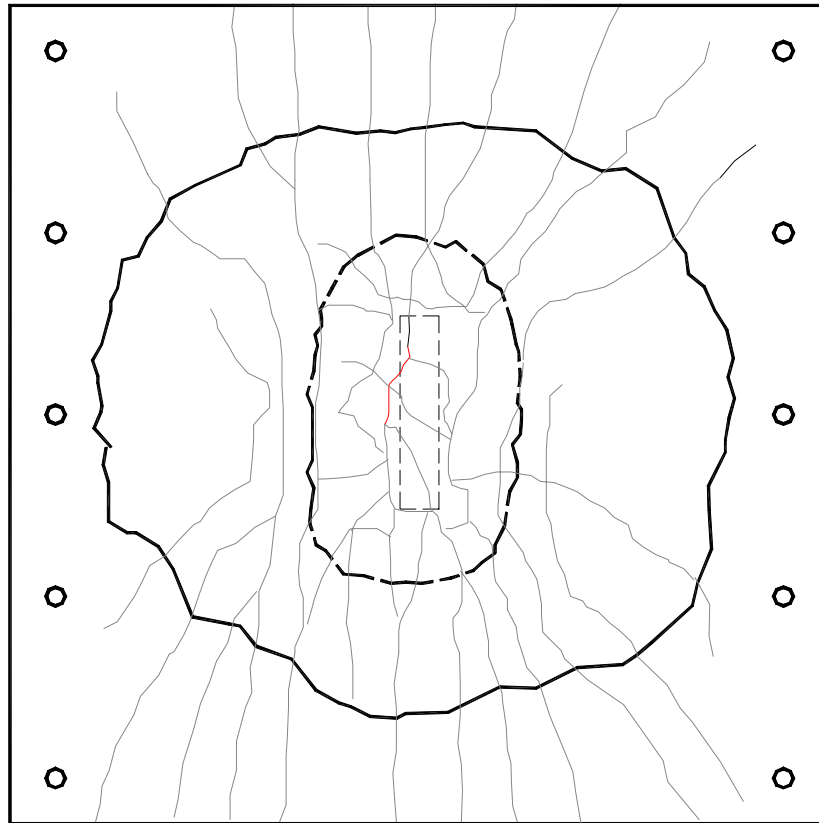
Mapa de fissuração da laje L3A
